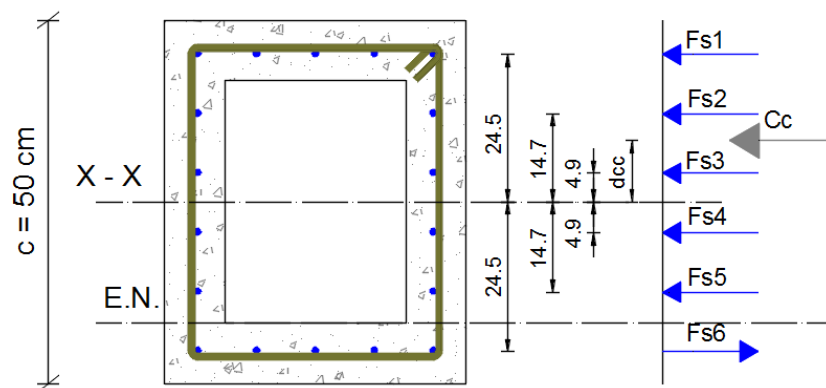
Esquema general de deformaciones, esfuerzos y fuerzas en la sección transversal rectangular
